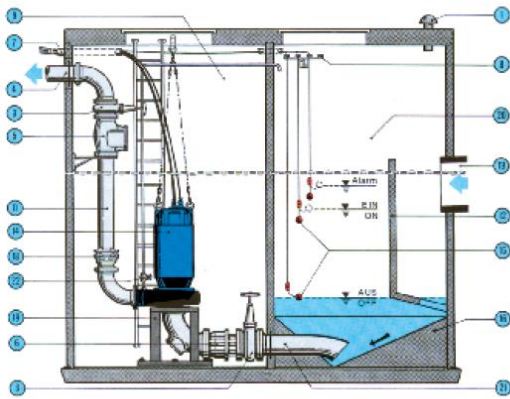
Διάταξη Υποβρύχιου αντλητικού συγκροτήματος
